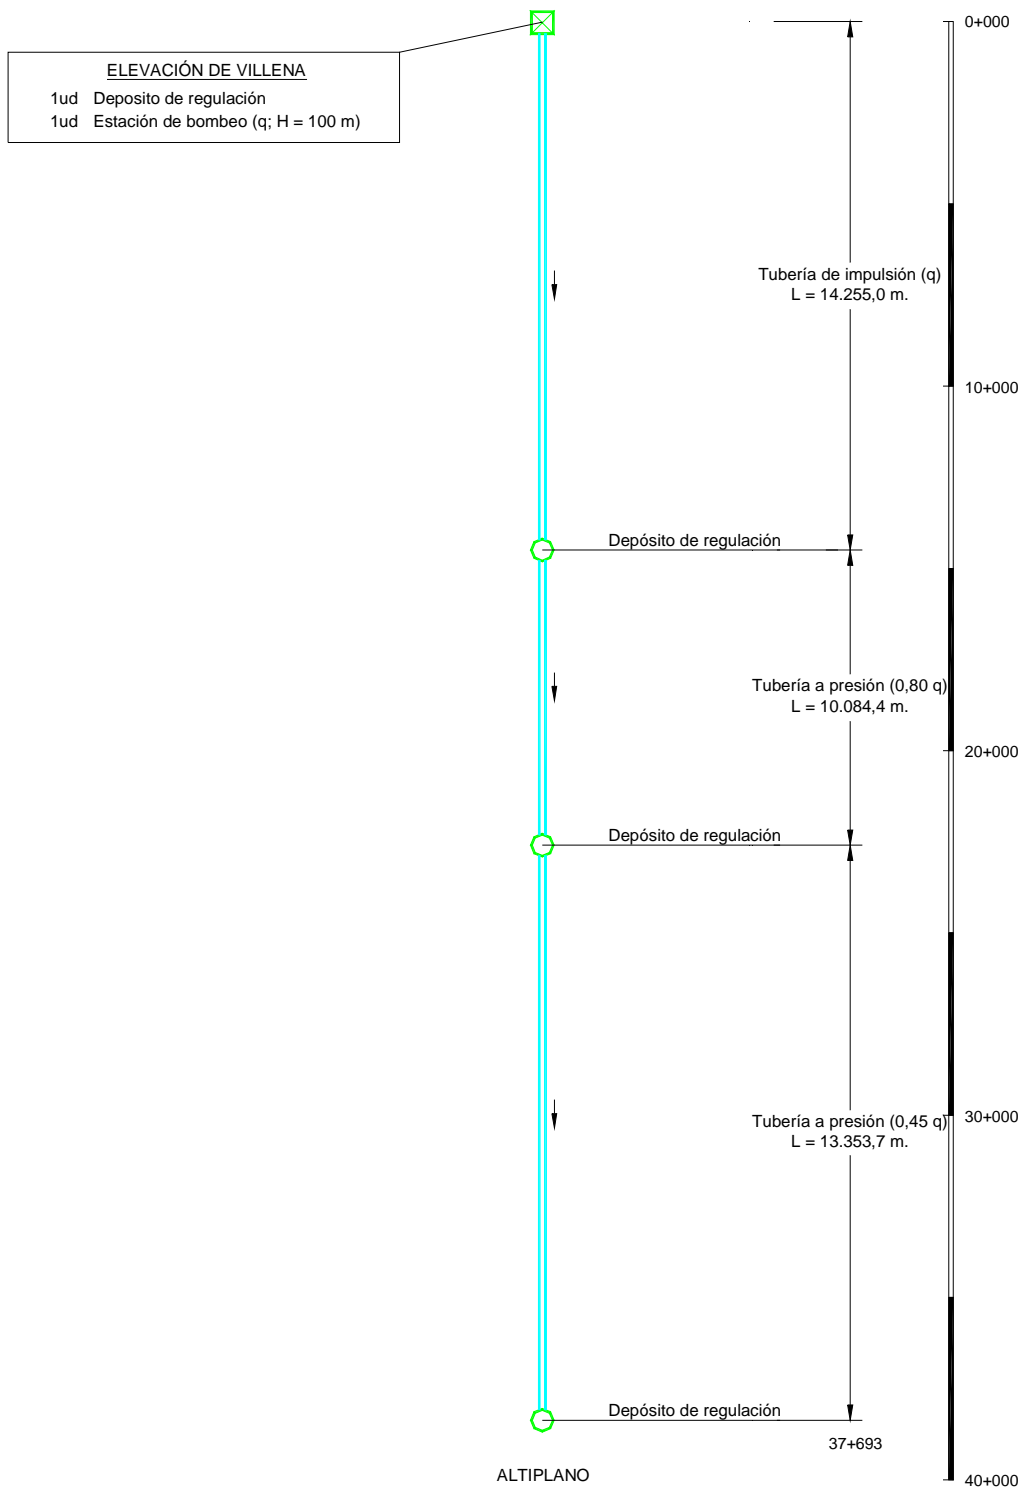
Conducción Villena-Altiplano. Esquema en planta
